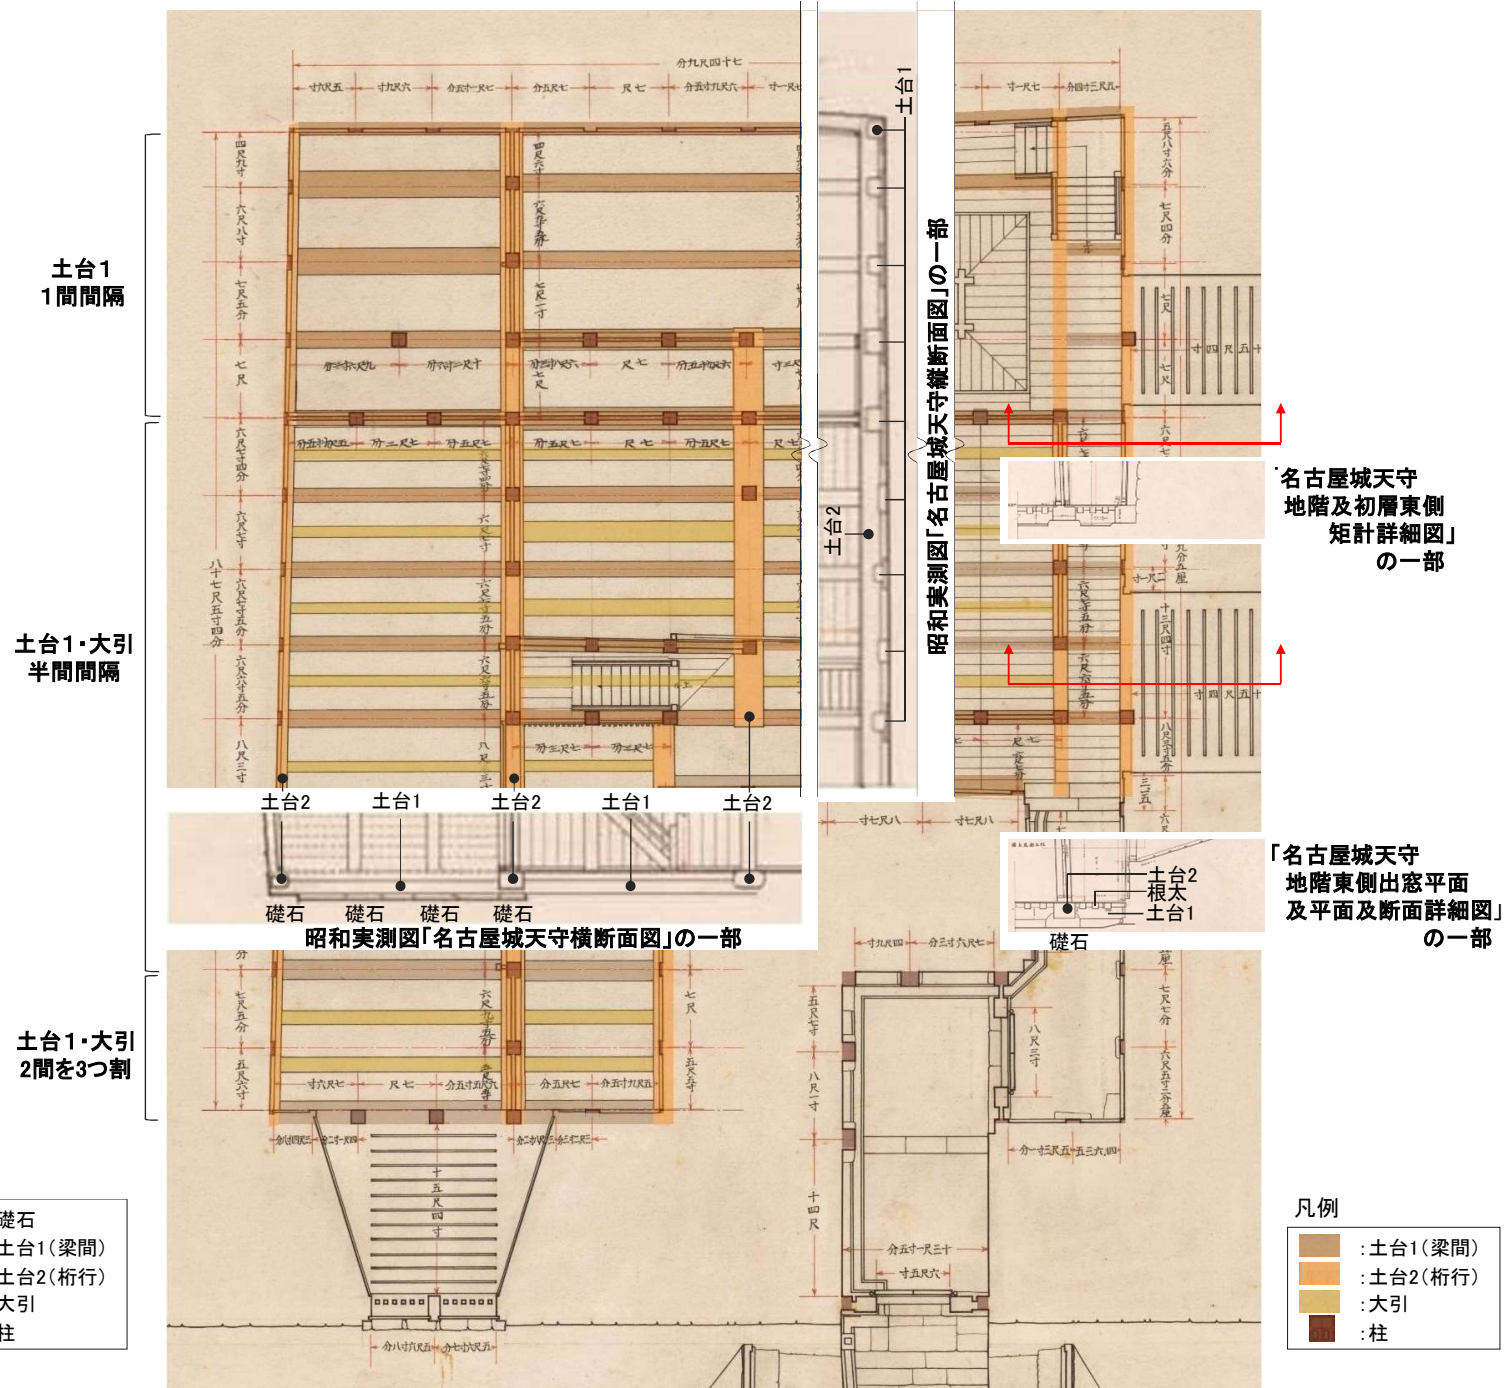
昭和実測図「地階平面図」による地階土台の検証
